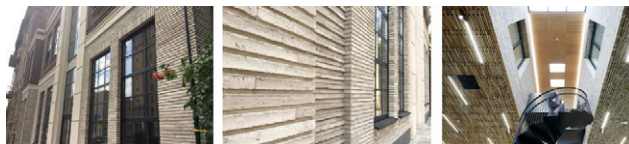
Применение ригельного формата кирпича на фасаде и внутри офиса
